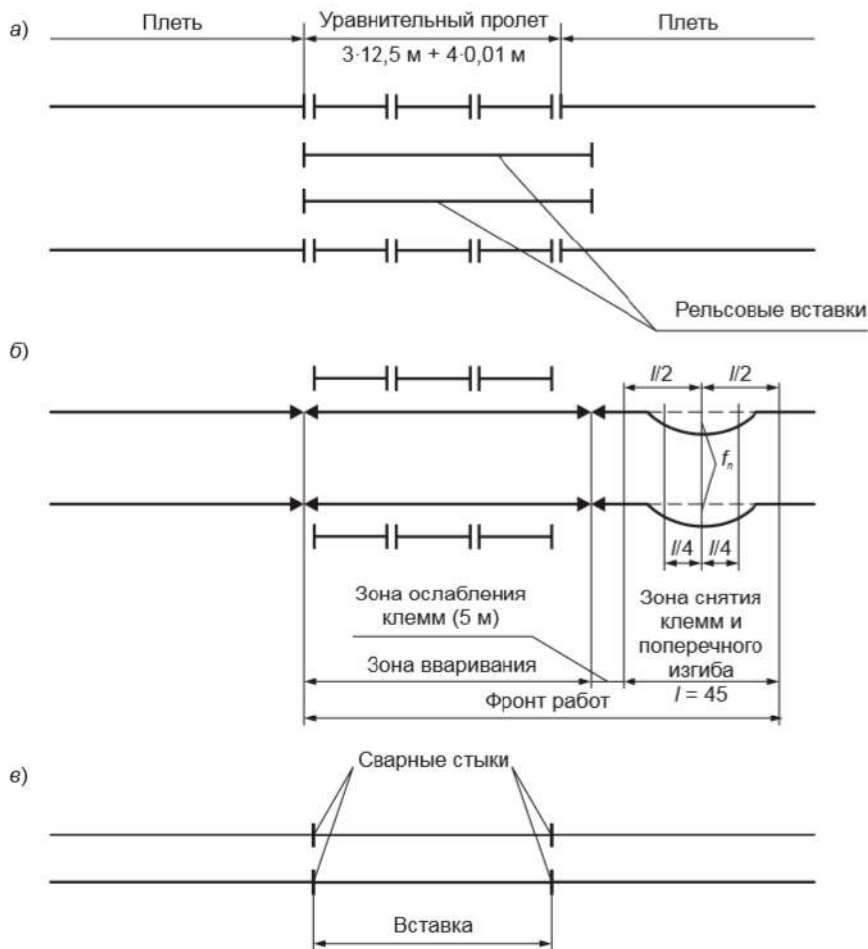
Схема фронта работ и последовательность операций при создании длинных рельсовых плетей в процессе эксплуатации: а – схема уравнительного пролета с подготовленными к сварке рельсовыми вставками; б – схема разметки места сварочных работ; в – состояние участка после окончания работ
